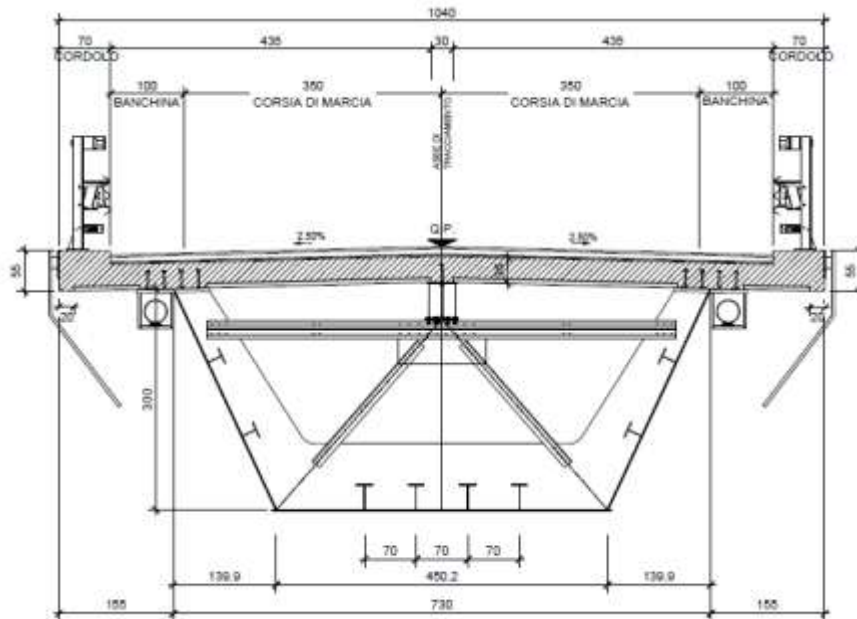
3 SEZIONE IN CORRISPONDENZA DEI PONTI SU PANARO E BURANA
